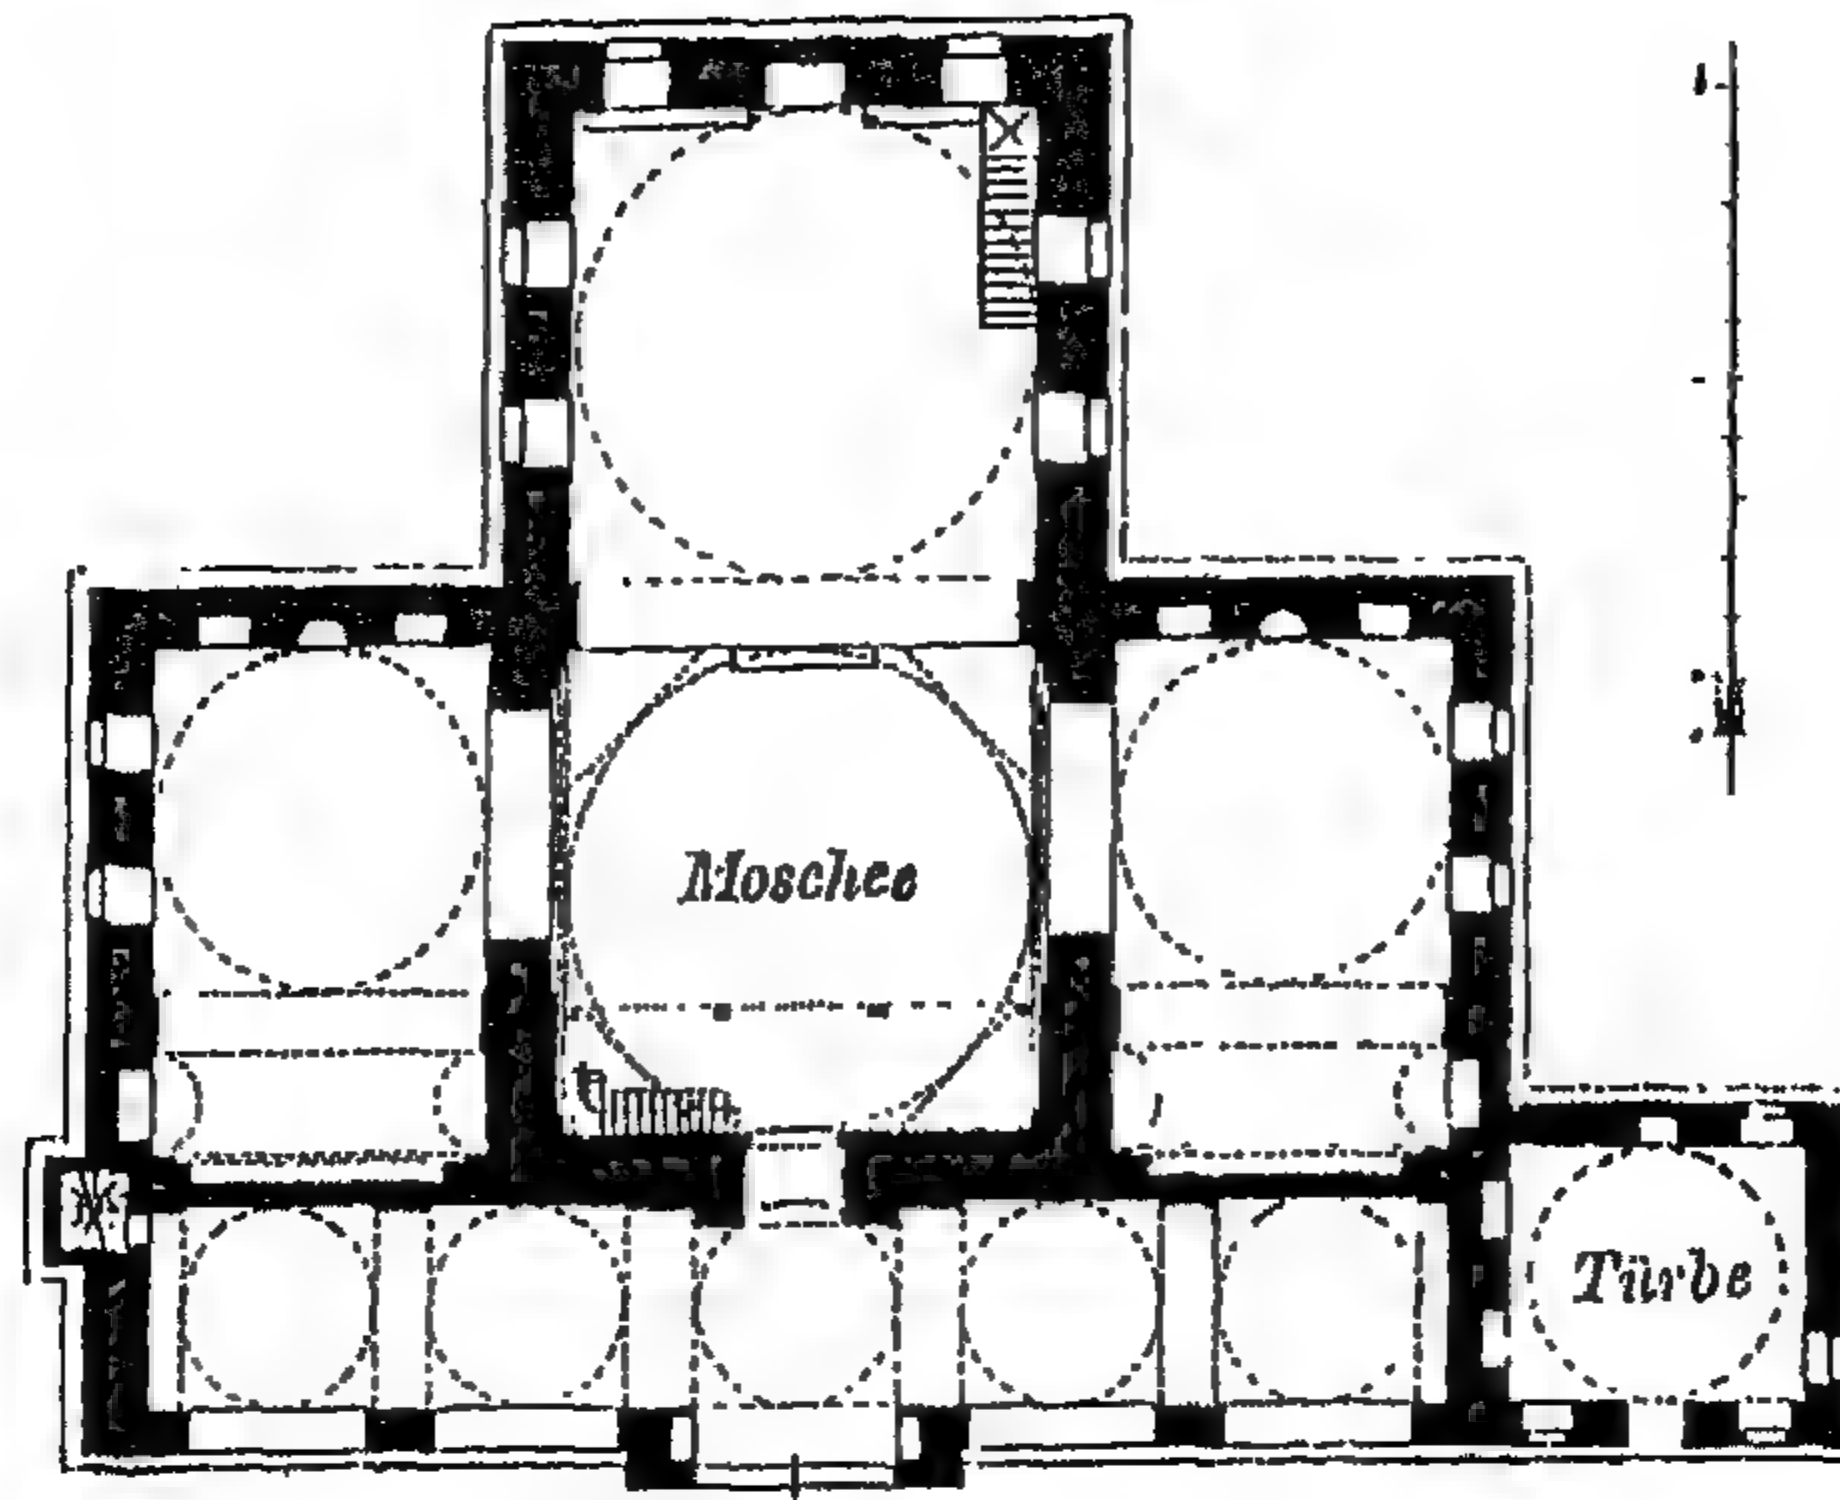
مسقط أفقي لجامع الفاتح
